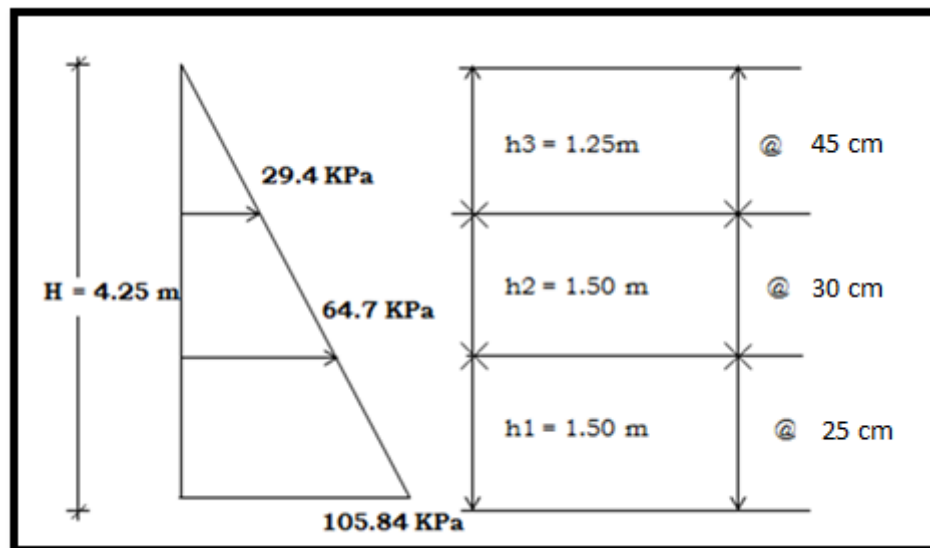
Distribución de presiones y refuerzo en columna diseñada. (Elaboración propia).
